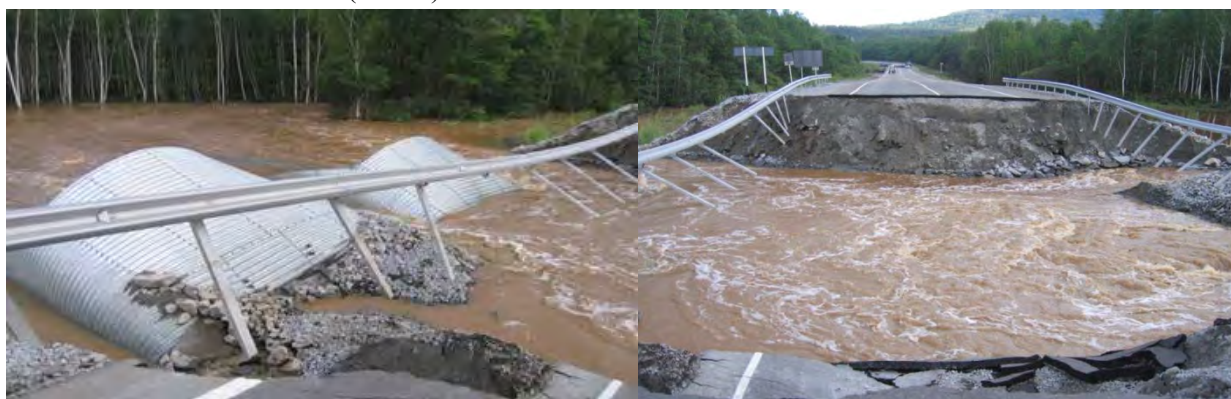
а) отказ стальных водопропускных труб; б) размыв насыпи.
